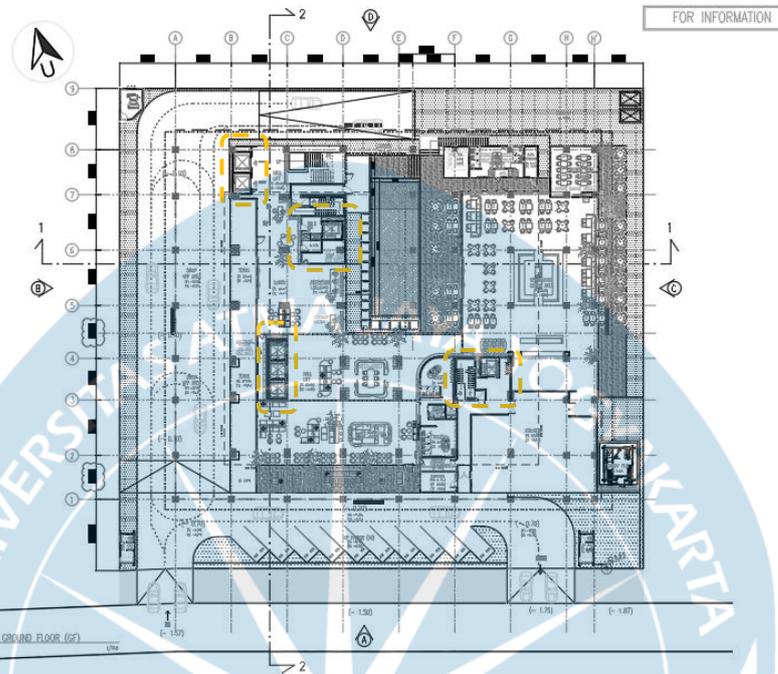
103 Denah Instalasi Saluran Air Lantai Ground Floor (Sumber: Data Teknis Proyek)
